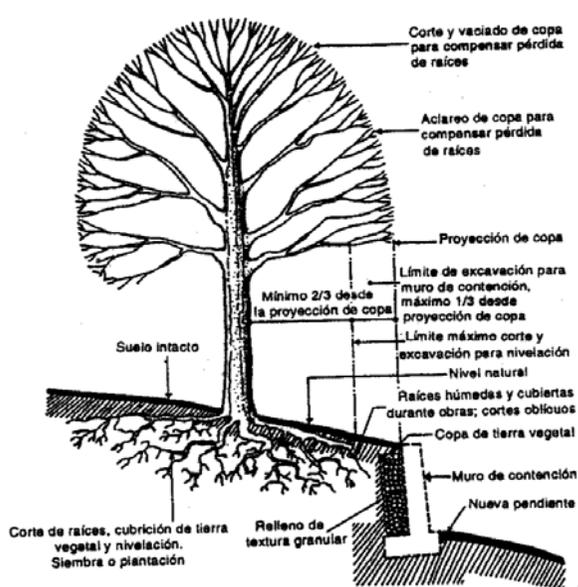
Elementos de protección, Rebaje en pendiente.
